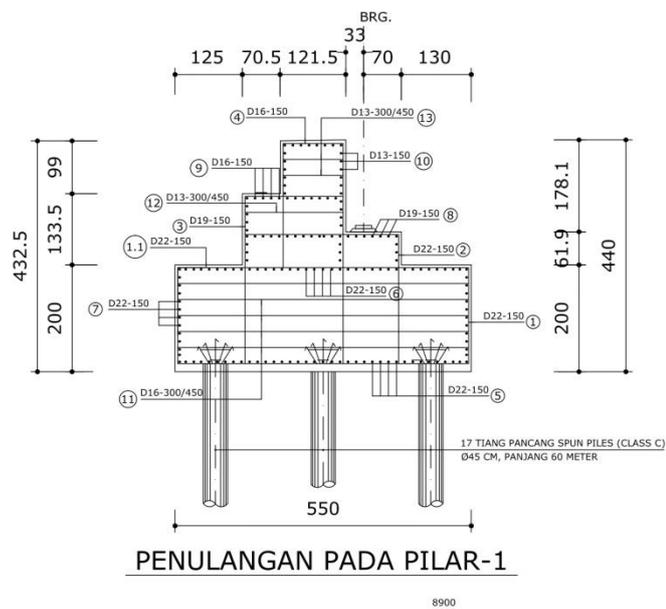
6 Tampak Melintang Tiang Pancang Beton
